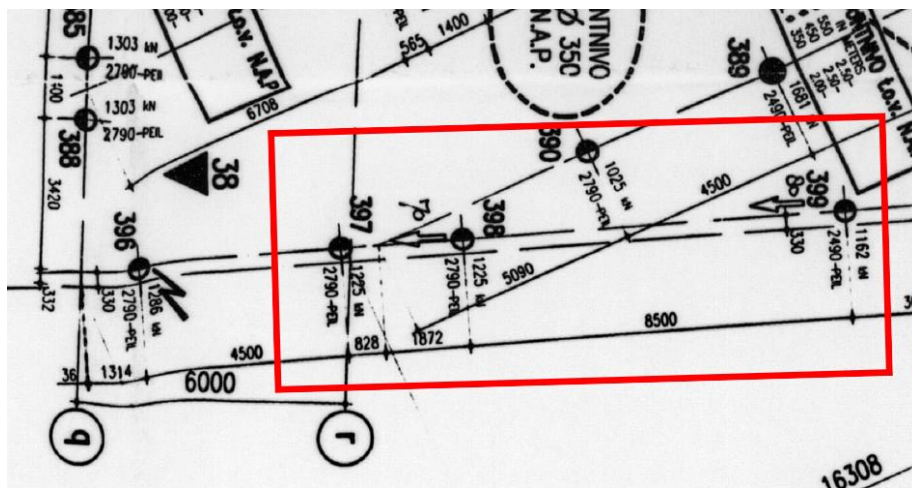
positie betonconstructie volgens archiefstukken
